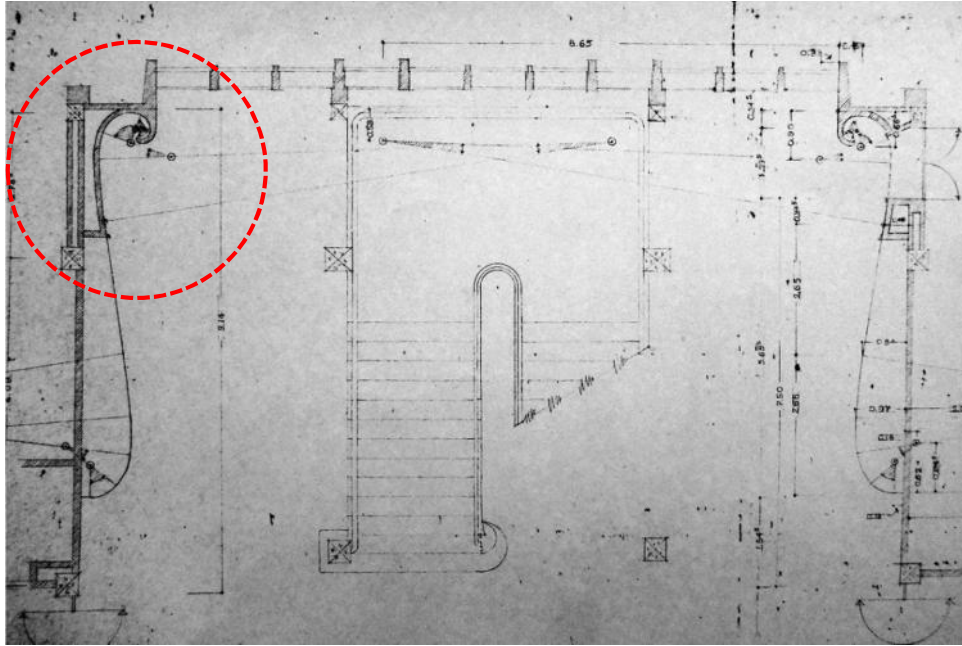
Junio 5 de 1944. Planta del vestíbulo – proyecto no realizado.
